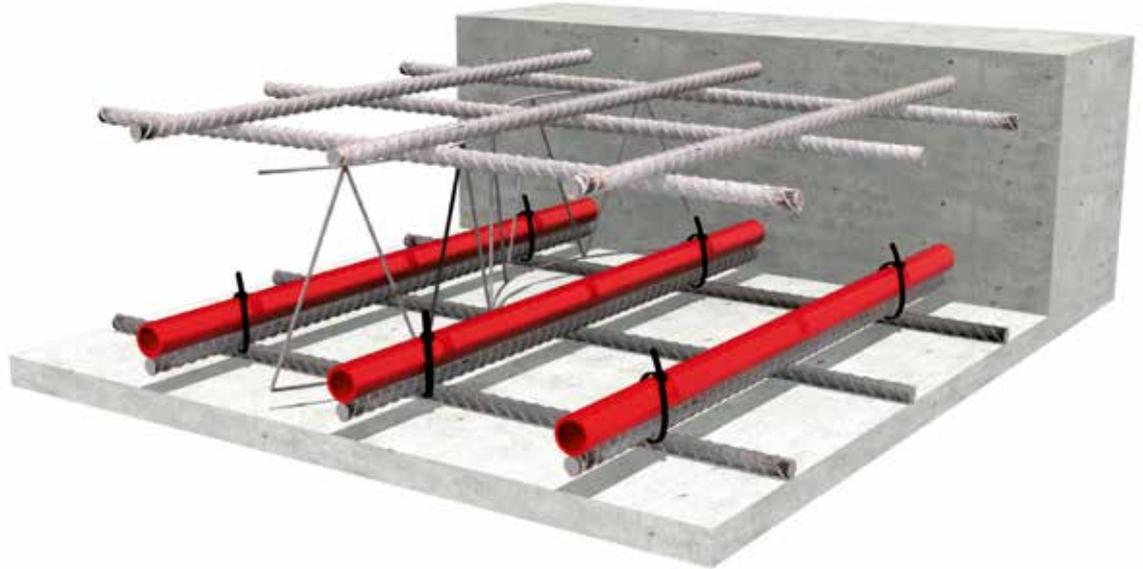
Schemaskizze des Aufbaus einer thermisch aktivierten Betondecke, © Z + B
